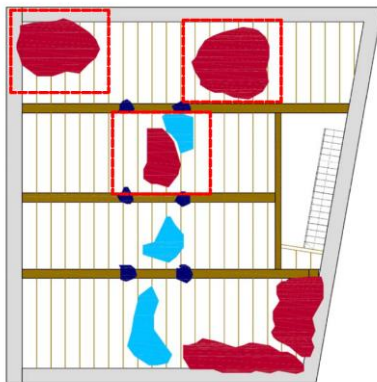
Localización zonas de viguetas con fisuras. 2023. Fuente: propia.
